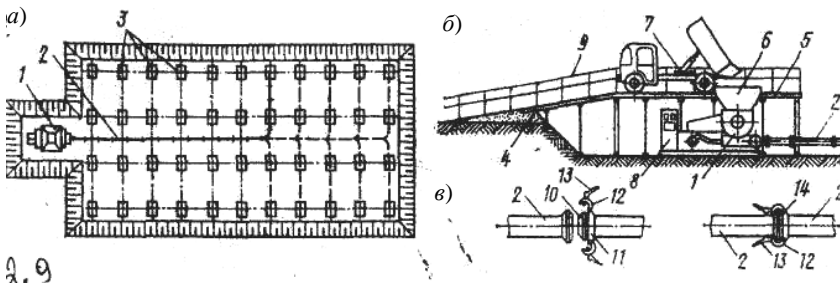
Подача бетонной смеси бетононасосами:
